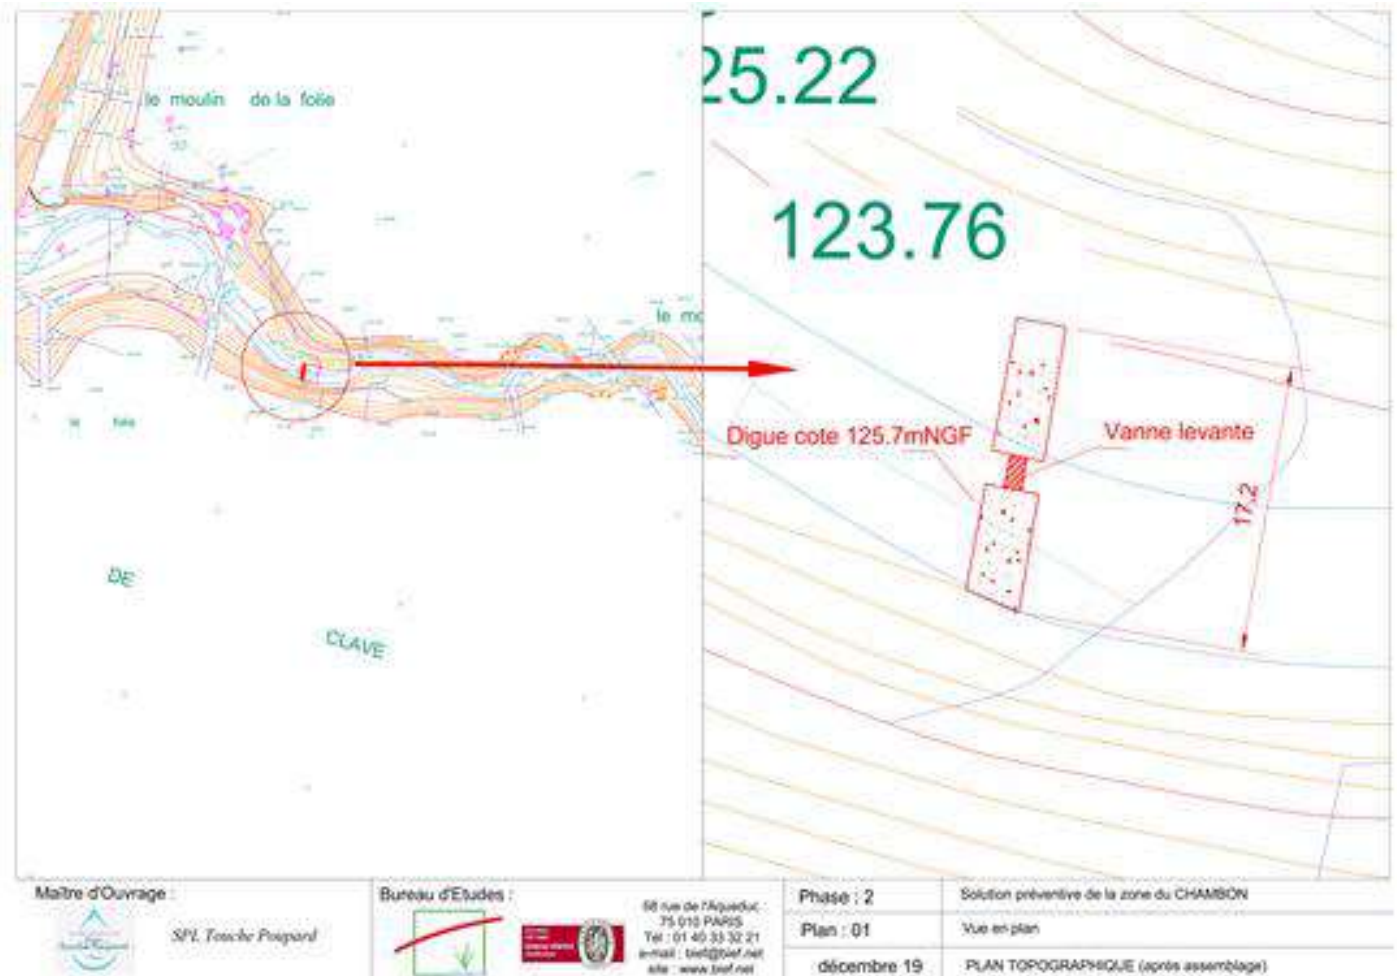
Vue en plan du scénario préventif au niveau de la zone du CHAMBON
